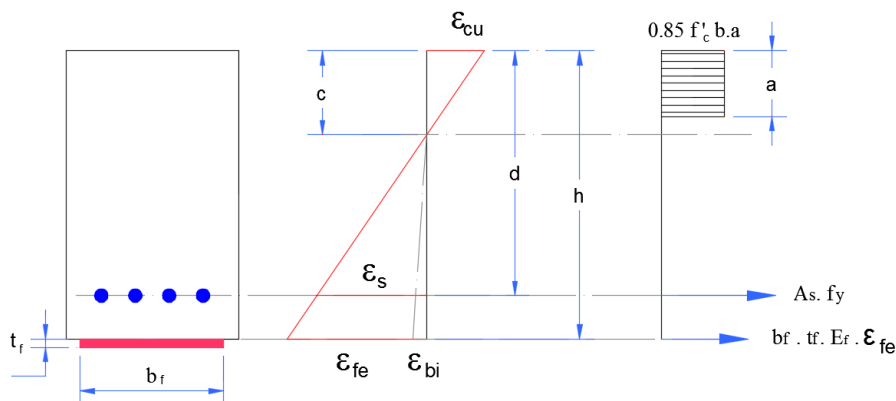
Mecanismo resistente a flexión de viga de concreto armado externamente reforzado con FRP.
